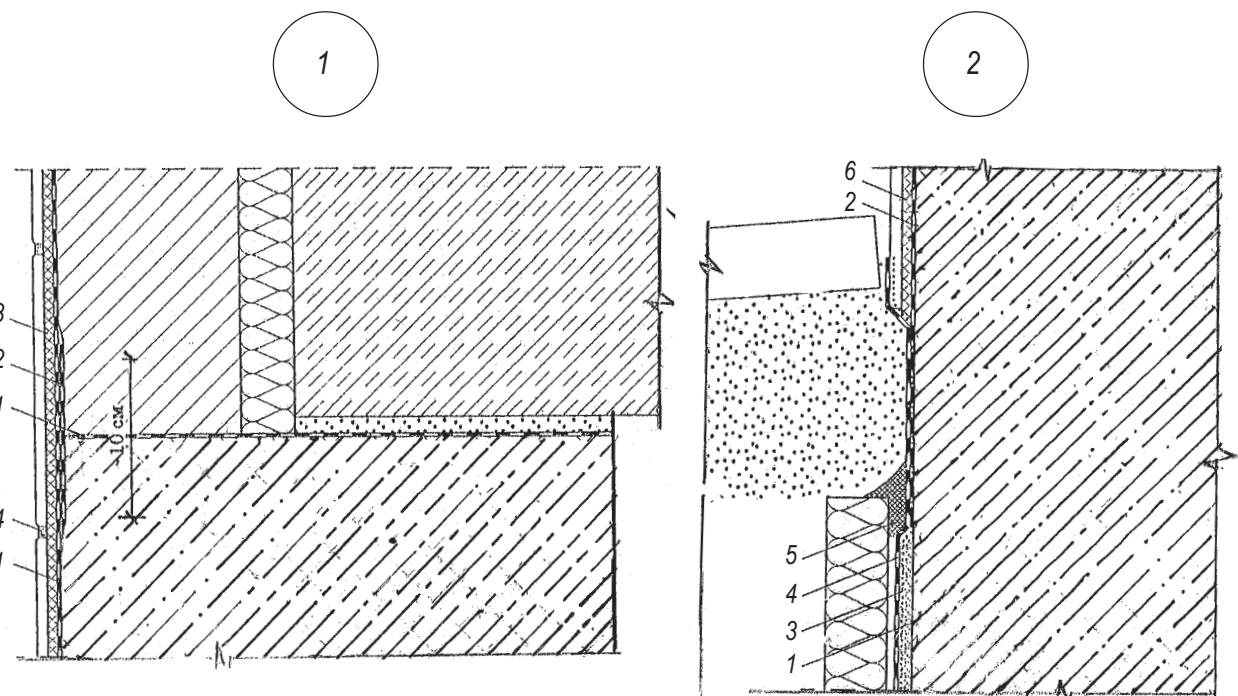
Стикування цокольної гідроізоляції та гідроізоляції під перекриттям:
